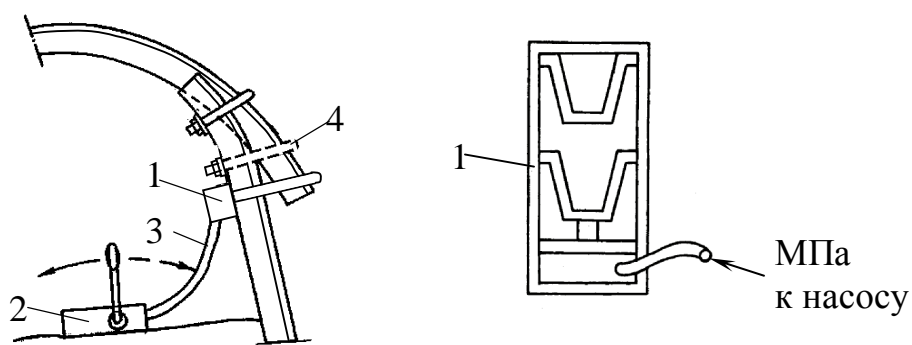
Восстановление сопротивления замкового соединения податливой крепи путём частичного стягивания верхняка со стойкой и установки нового хомута (скобы, планки и гайки): 1– стяжное гидравлическое устройство; 2– ручной насос; 3– высоконапорный гибкий шланг; 4– новый устанавливаемый хомут
